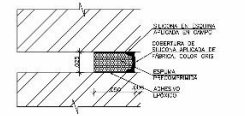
Plano de Detalles Constructivos (Acabados I) - Elaboración propia
